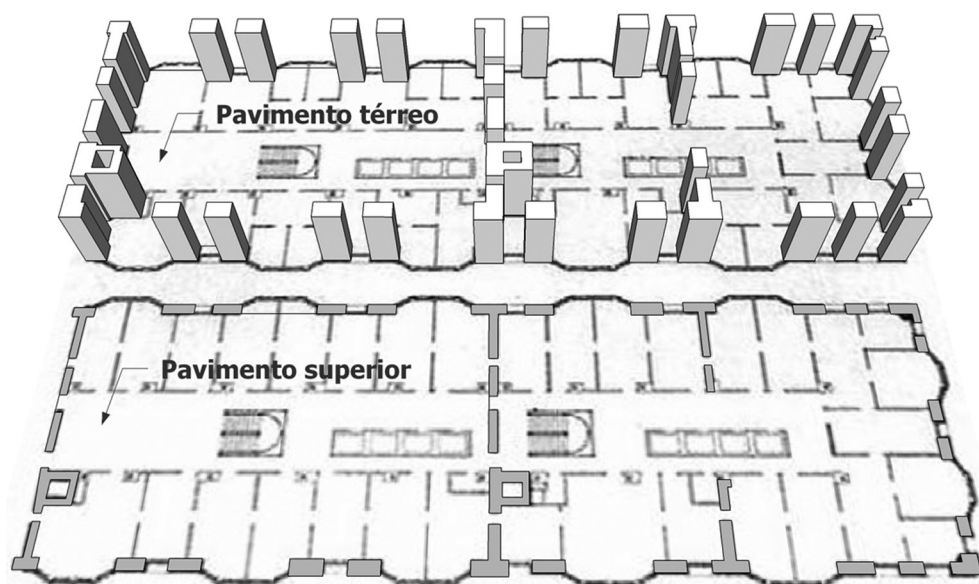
Monadnock Building, construído entre 1889 e 1891 em Chicago, nos Estados Unidos.
